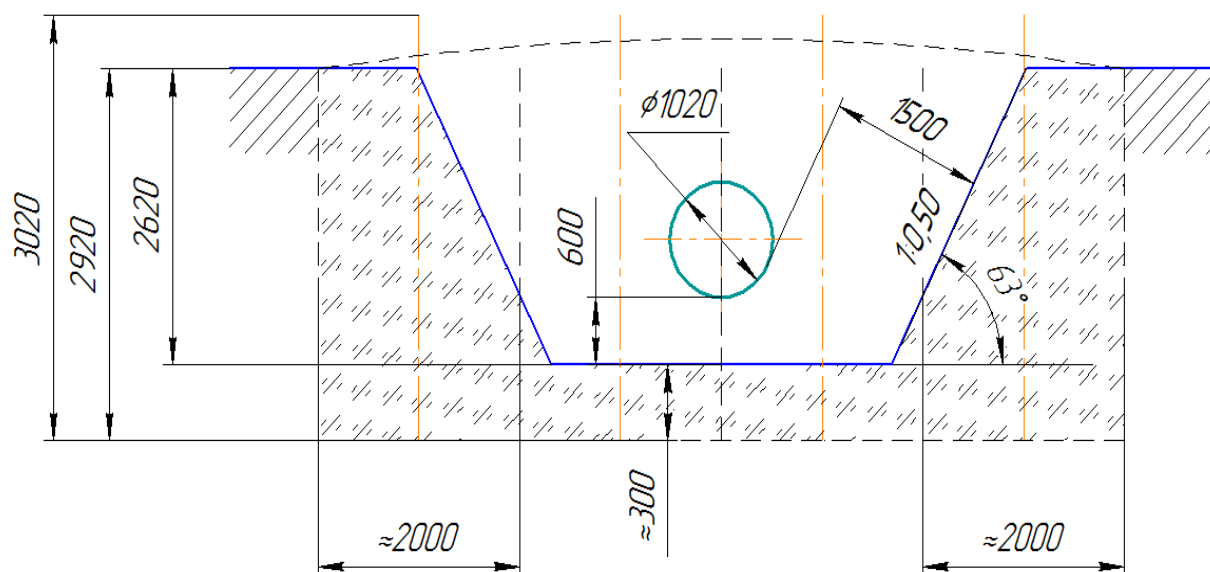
Поперечный разрез котлована и ледогрунтового ограждения при вырезке катушки диаметром 1020 мм. Водоупор находится ниже уровня дна котлована
